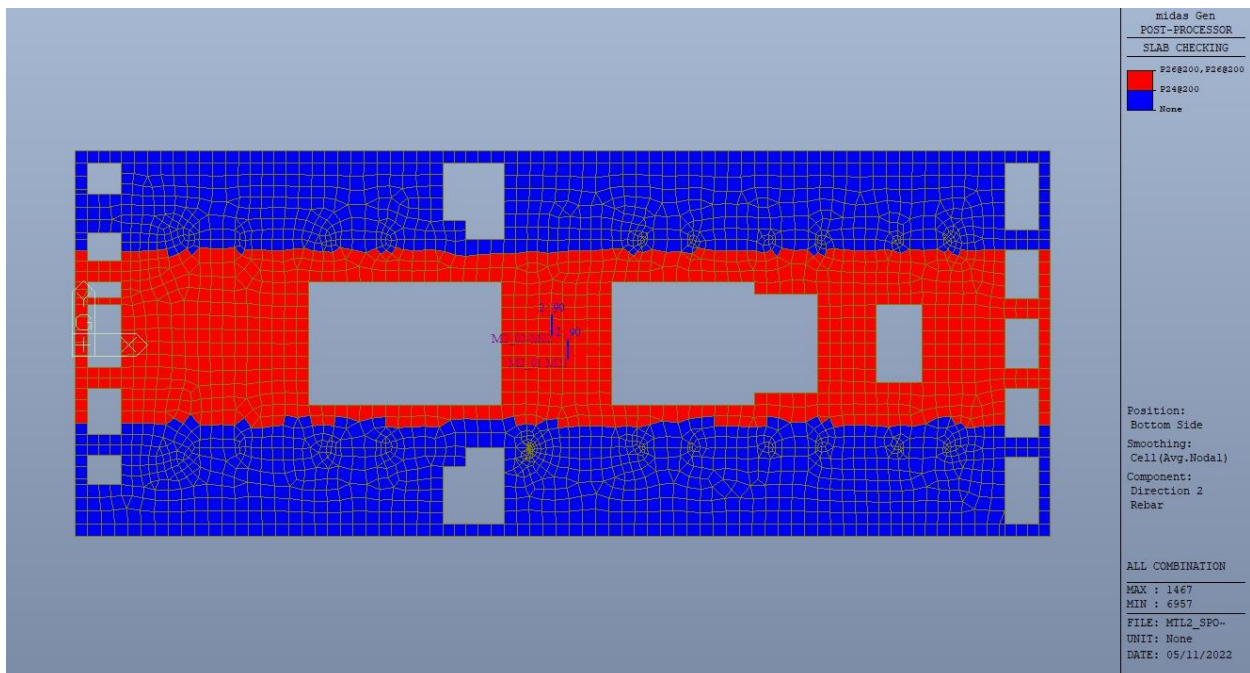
Piano mezzanino (-2) – Armatura inferiore direzione D2
